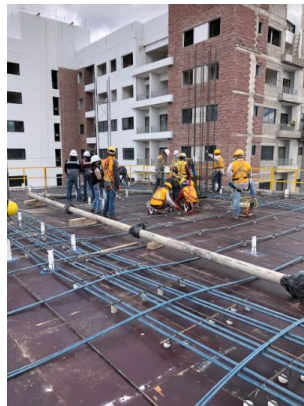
Inicio de colado de elementos estructurales de losa N-08
